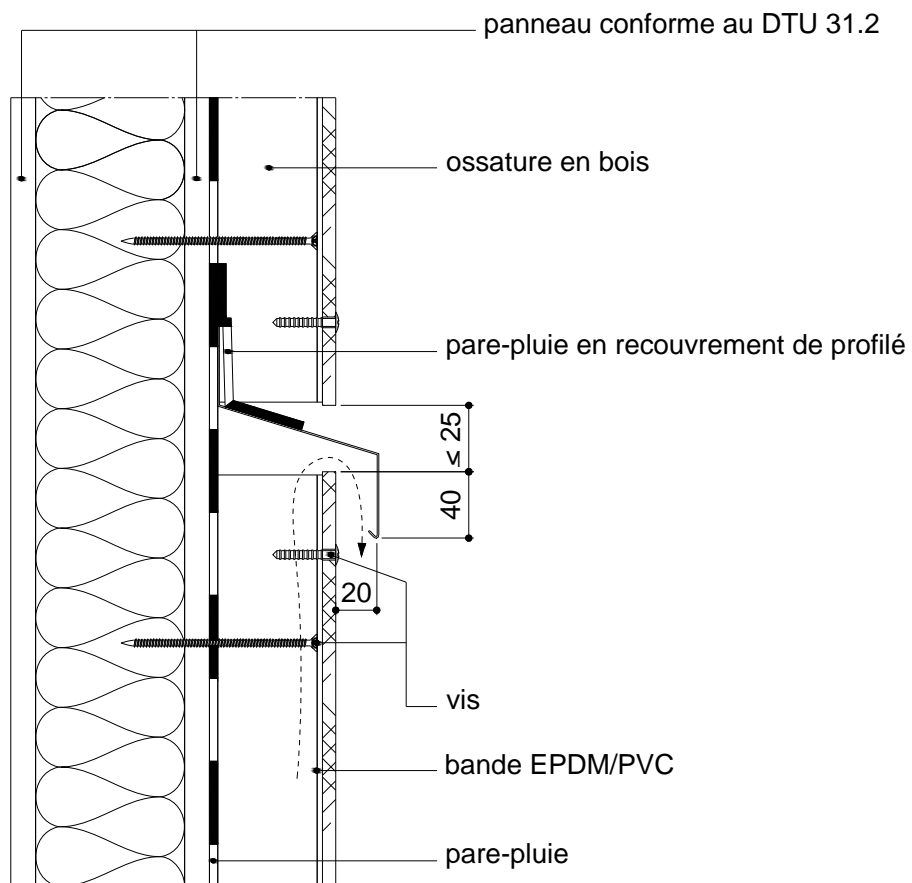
Recouvrement de pare-pluie tous les 6 m sur COB (cote en mm)
